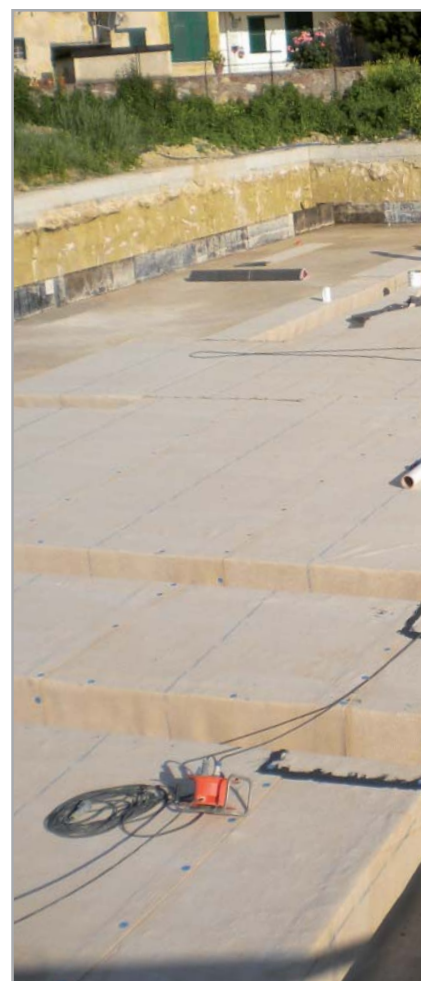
Impermeabilizzazione della platea nervata mediante applicazione di MAPEPROOF
